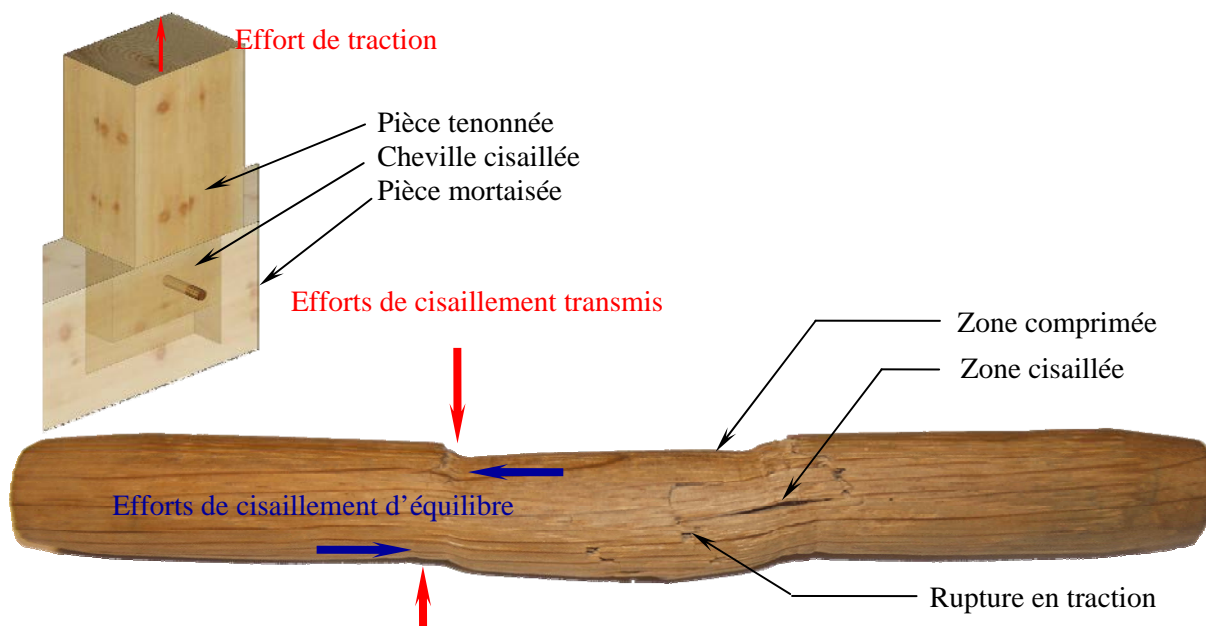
Faciès de rupture de chevilles en chêne après cisaillement dans un assemblage tenon mortaise.
